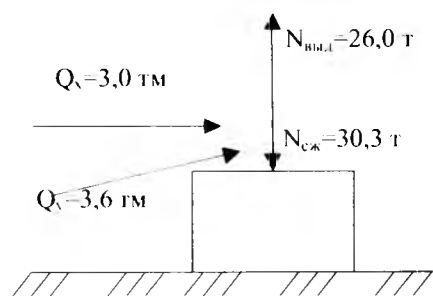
Схема нагрузок на каждую ногу (сваю) опоры У 110-4
